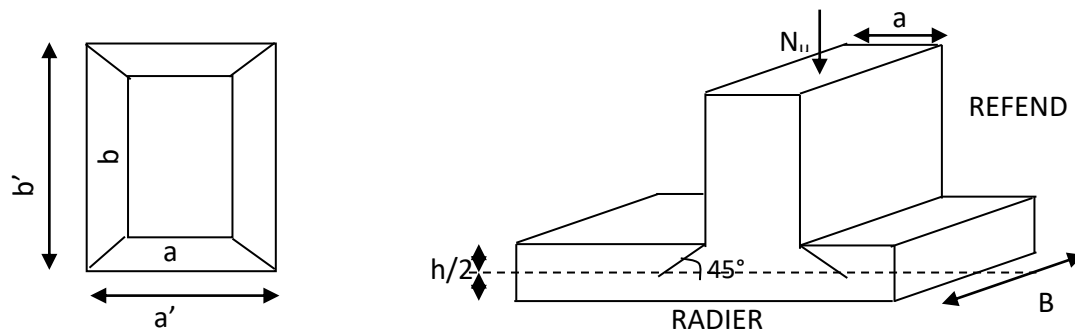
Périmètre utile des voiles et des poteaux
